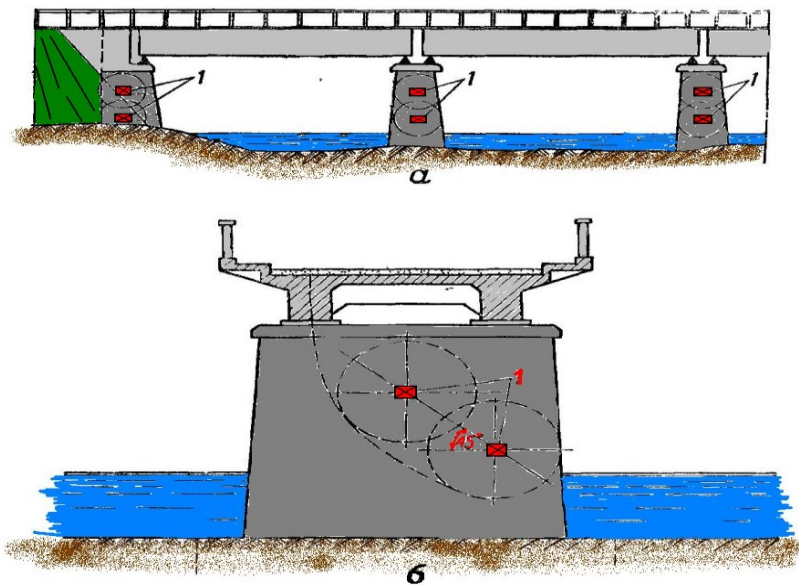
Взрывание балочного железобетонного моста разрезной конструкции:
